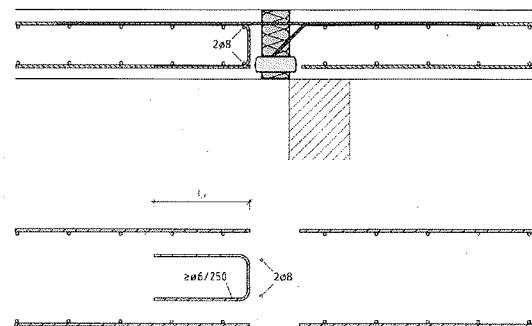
Bewehrungsführung MQ bei direkter Lagerung
